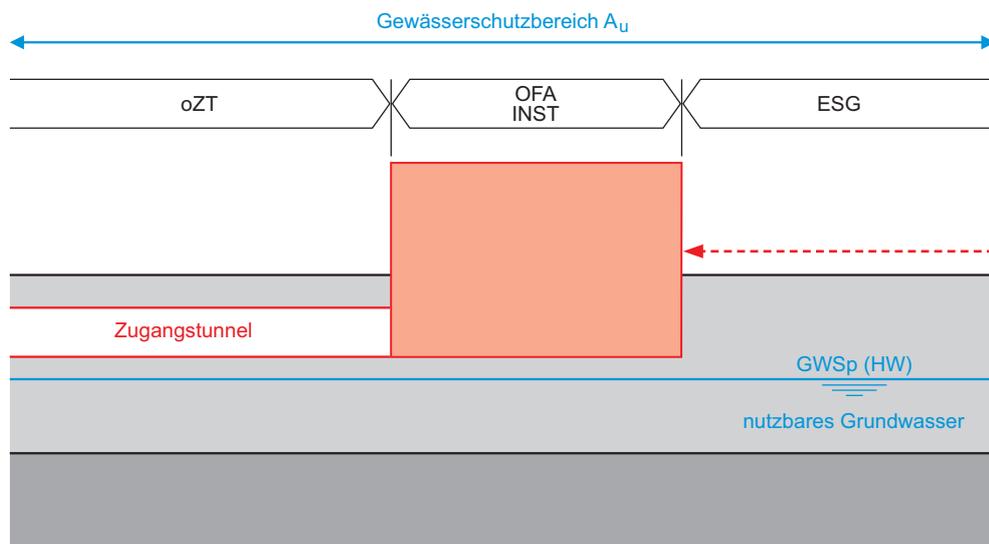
Grundwassersituation Typ B – Bauwerk im Gewässerschutzbereich A_u über dem nutzbaren Grundwasser mit grossem Flurabstand; alle Bauwerksteile liegen deutlich über dem höchstmöglichen Grundwasserspiegel.
